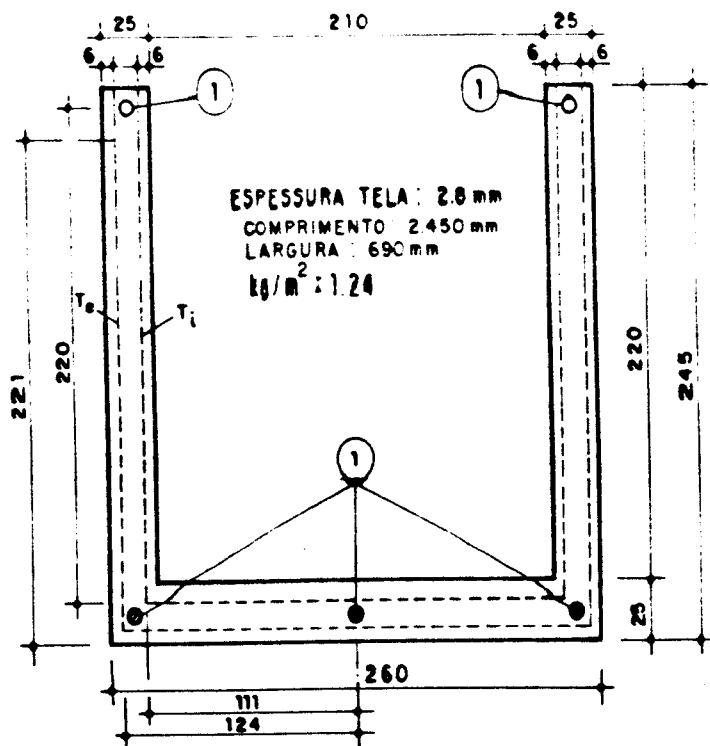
Seção Transversal das vigas<sup>(18)</sup>
